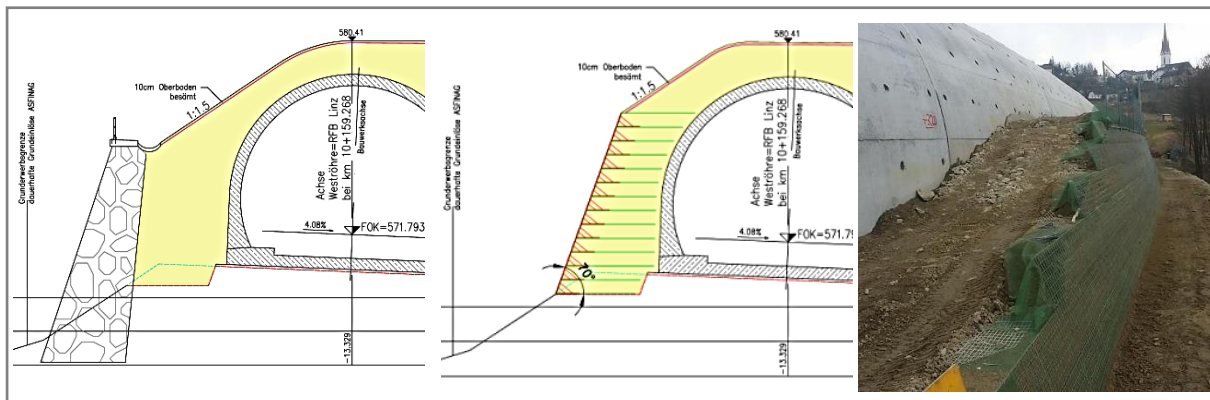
Querschnitt Stützmauer (links), Querschnitt KBE (Mitte), Ausführung KBE (rechts) ©NAUE
